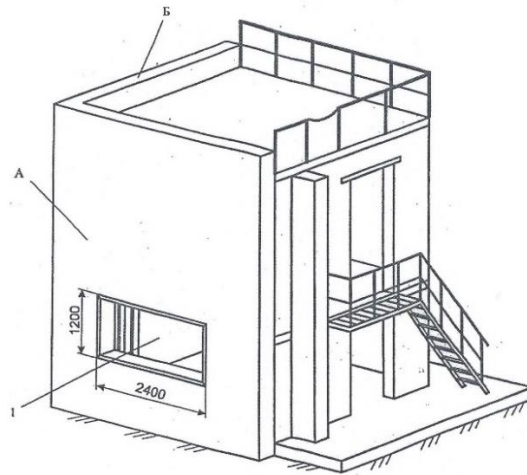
Фрагмент будівлі для випробування фасадної системи на поширення вогню [11]
